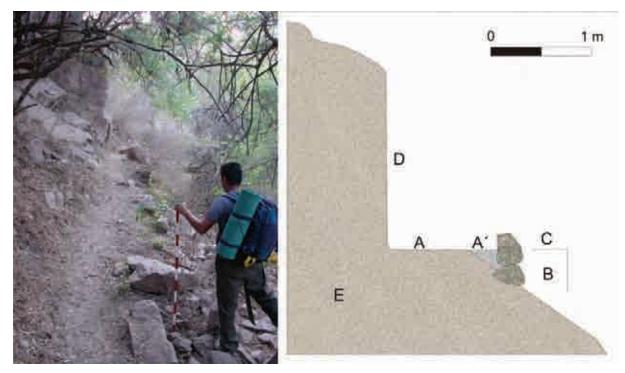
Segmento de camino con talud y excavación dentro de la ladera. Fotografía y esquema general de disposición de los elementos mencionados: A y A´= superficie del camino y relleno (ancho: 1,10 m); B= muro de contención ladera abajo; C= amojonamiento; D= sector ladera arriba excavado; E= ladera del cerro. Fotografía del autor.
